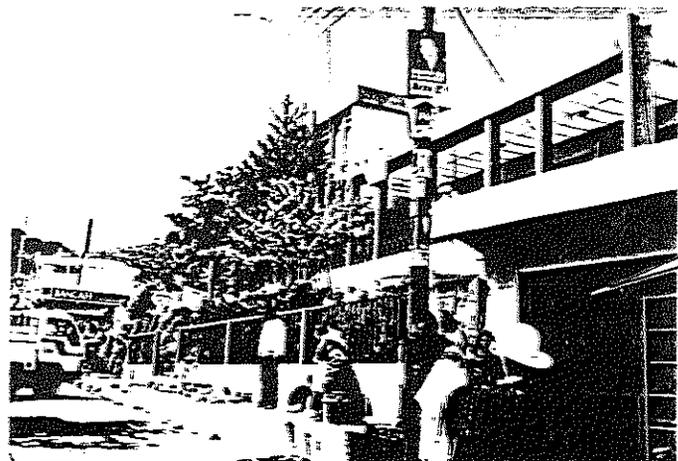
El Palacio Municipal de dos plantas proyectado para tres, construido con block y concreto reforzado. Por fachada, se remata con techo de dos vertientes con lámina de fibra de cemento (ondulada).
